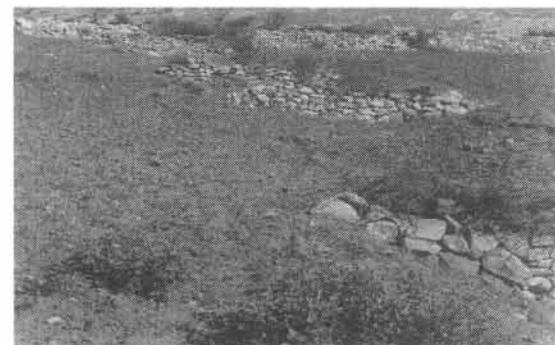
Ravin aménagé (seuils et plantation d'oliviers).
